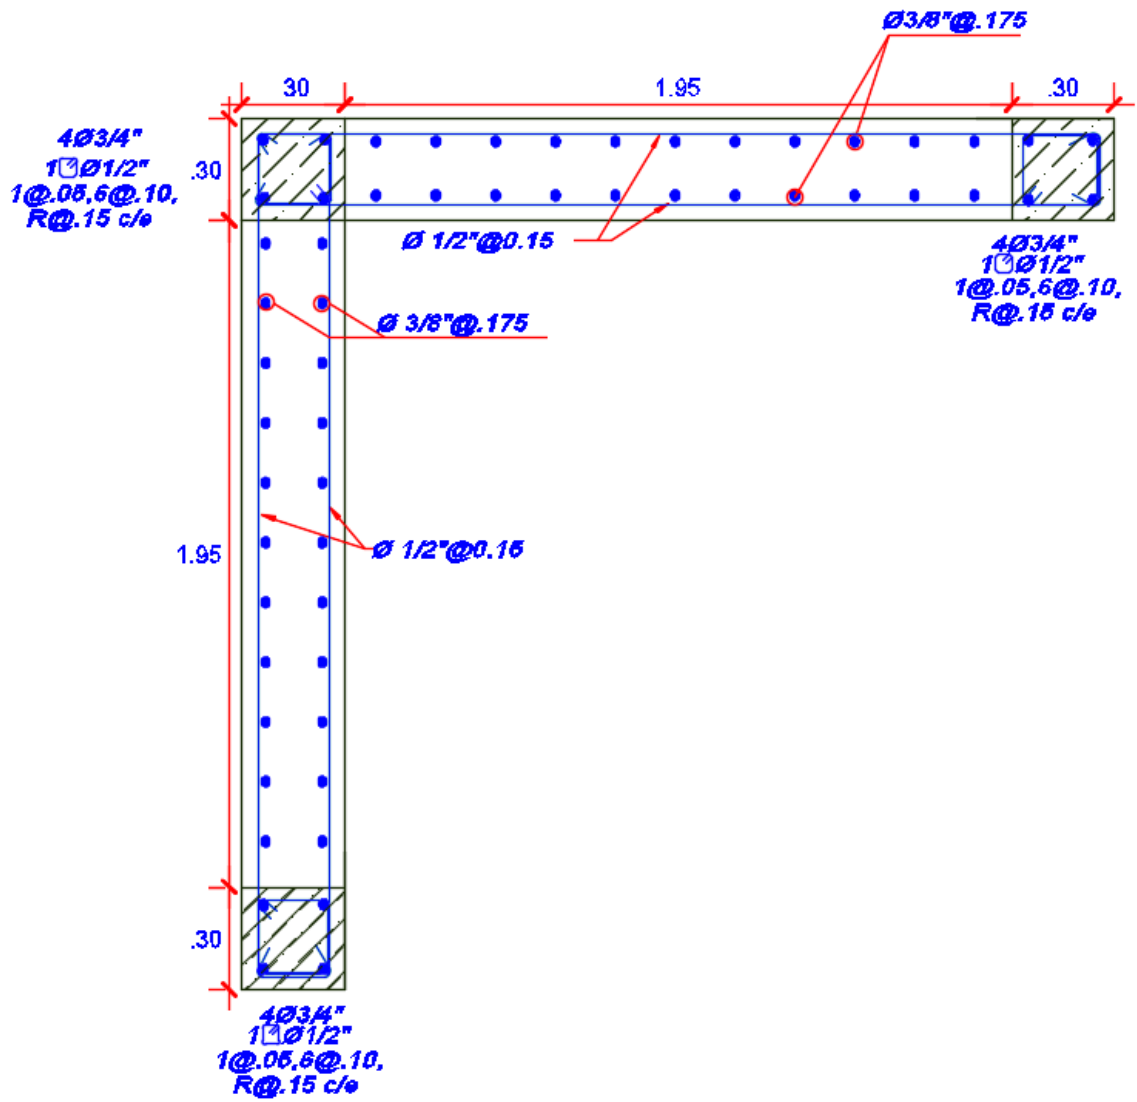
Plano final de la placa PL-01 (1-2 Piso)
